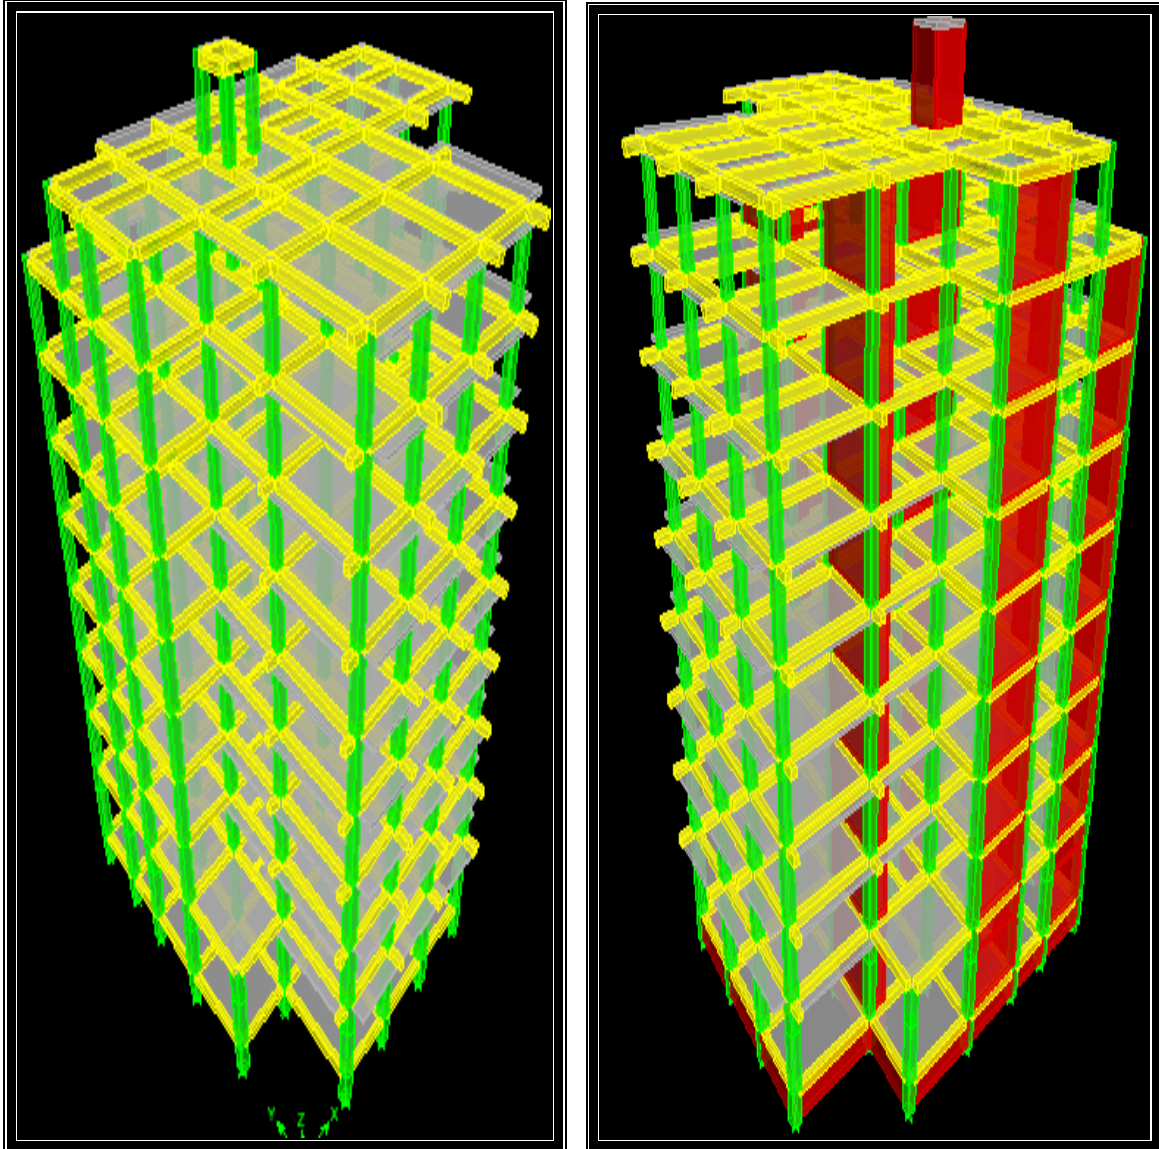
3 : Model tridimensionnel de la structure auto stable et mixte respectivement
